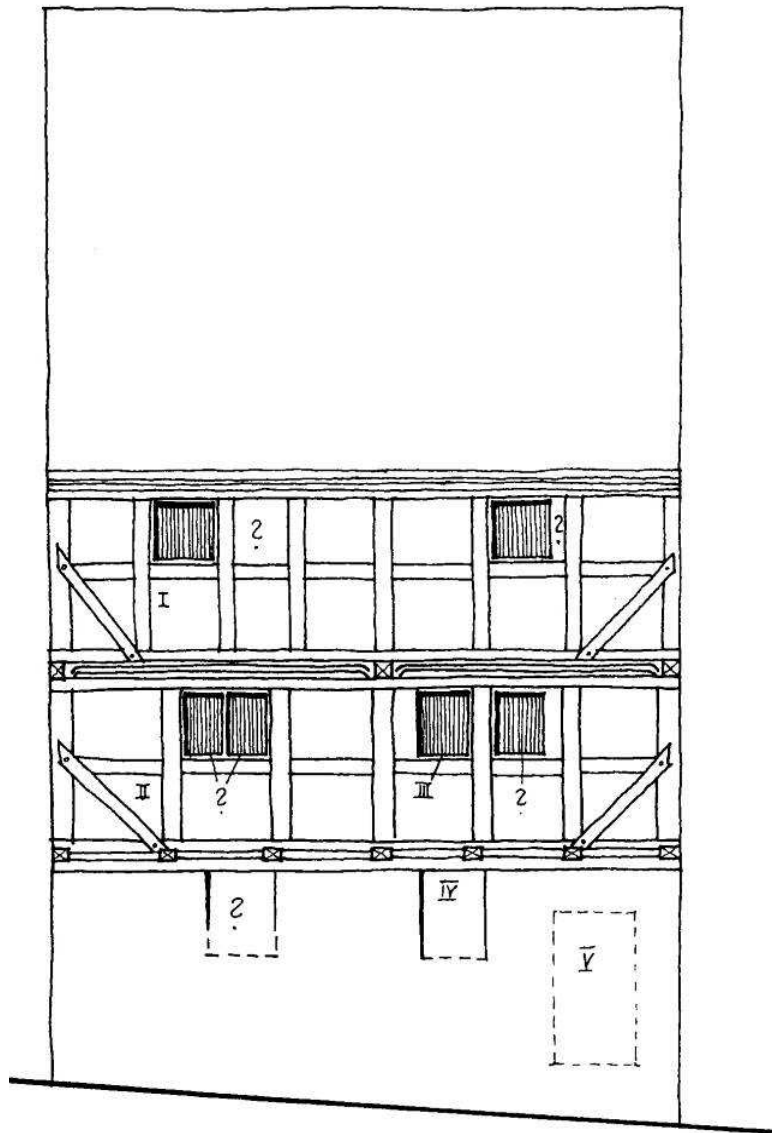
Schloßberg 3, Baulalterplan 2.Obergeschoß
